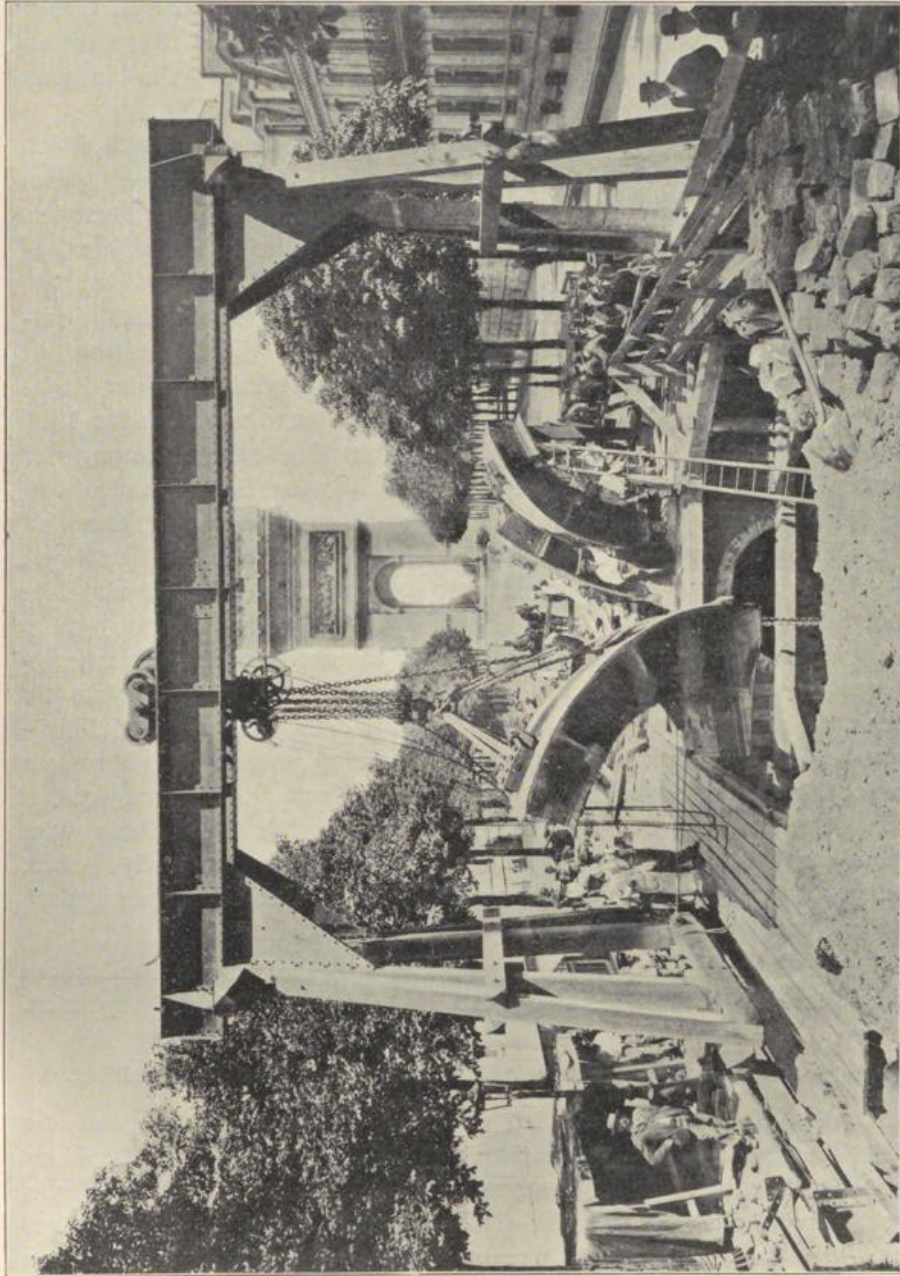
Herablassen der eisernen Schildsegmente bei tunnelierten Strecken.
